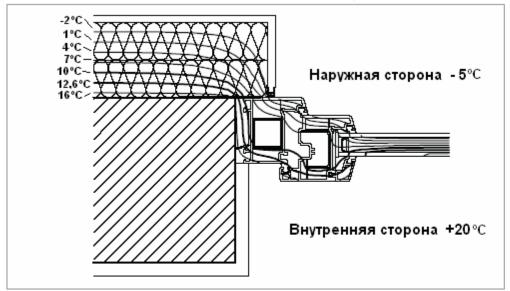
Бетонная стена с наружной изоляцией. Окно из профиля ПВХ, монтаж снаружи встык.
